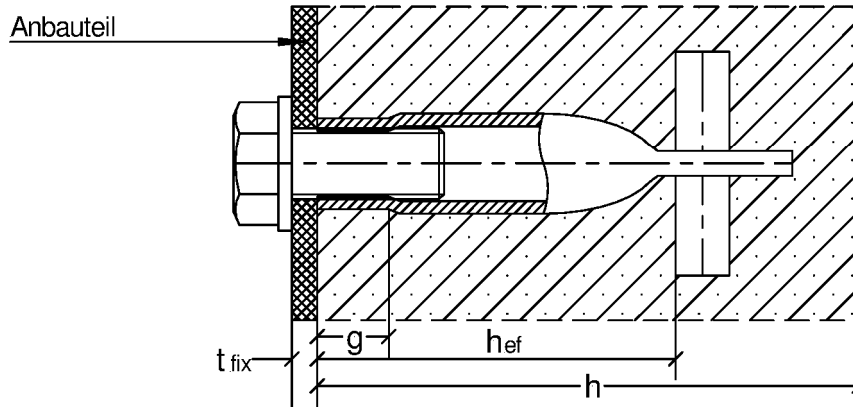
Schroeder-Gewindehülse mit angeschweißter Nagelplatte
